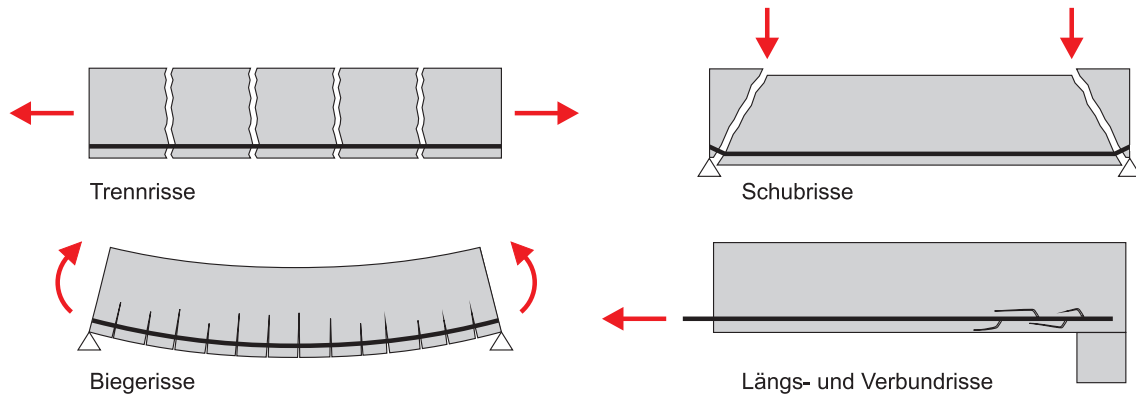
belastungsabhängige Rissbilder bei einem Stahlbetonbalken
